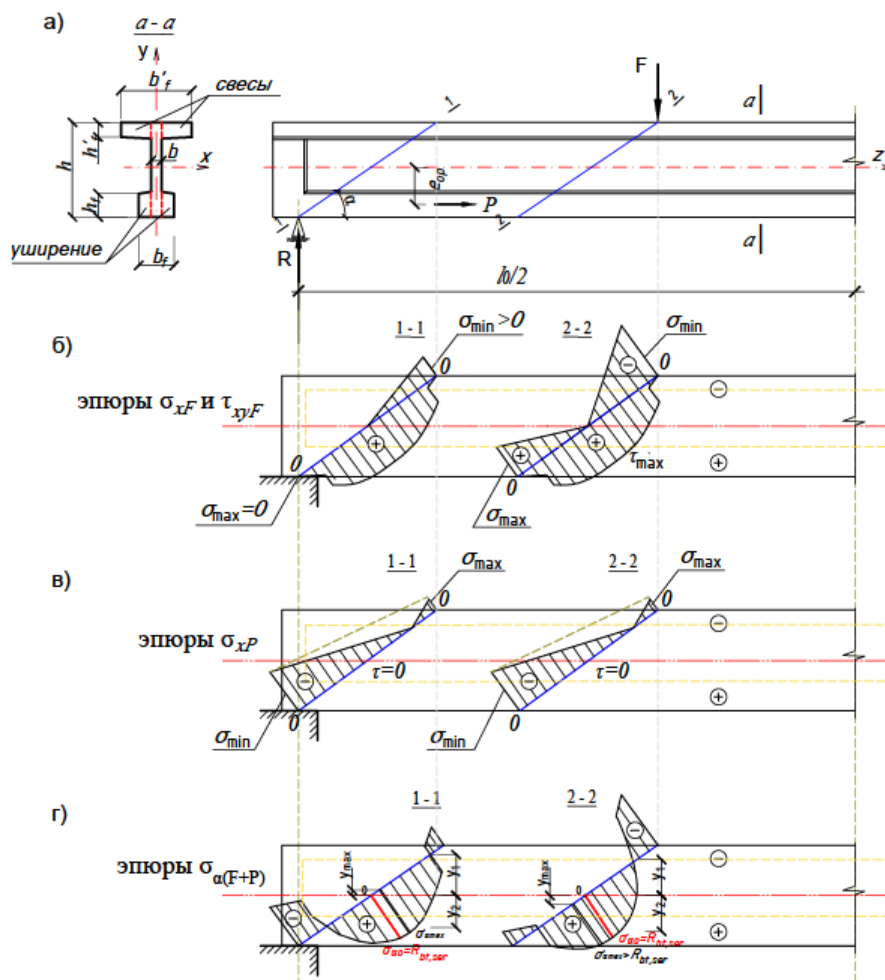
Схемы изменения характера эпюры нормальных напряжений σ_α с удалением наклонного сечения от опоры предварительно напряженной балки: а) расчетное сечение балки; б) эпюра σ_{xF} и τ_{xyF} от внешней нагрузки; в) эпюра σ_{xP} от продольной силы предварительного обжатия; г) суммарная эпюра $\sigma_{\alpha(F+P)}$.
